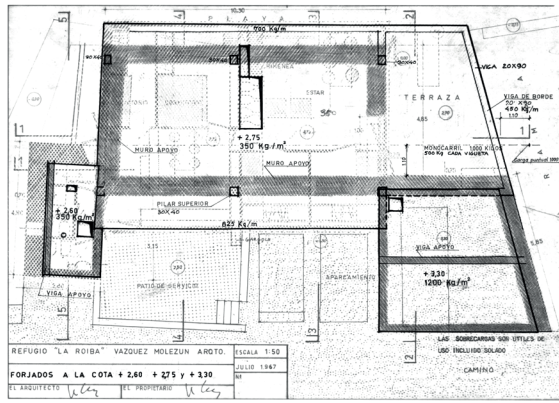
Plano de forjados, planta primera y segunda e: 1/50.
